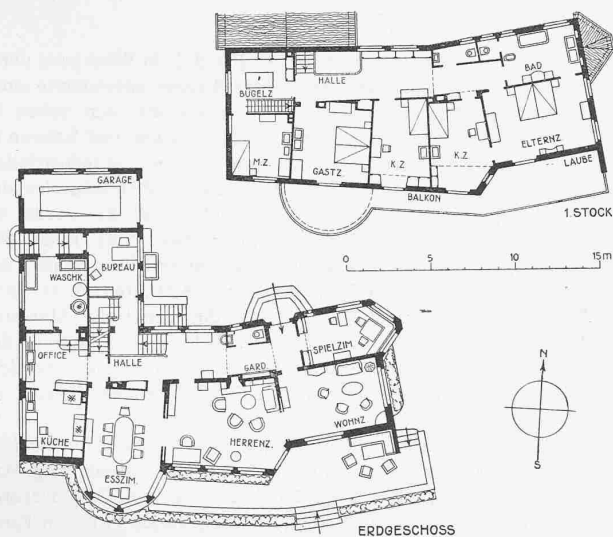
und 3. Grundrisse des Hauses Seegut. — 1 : 400.
